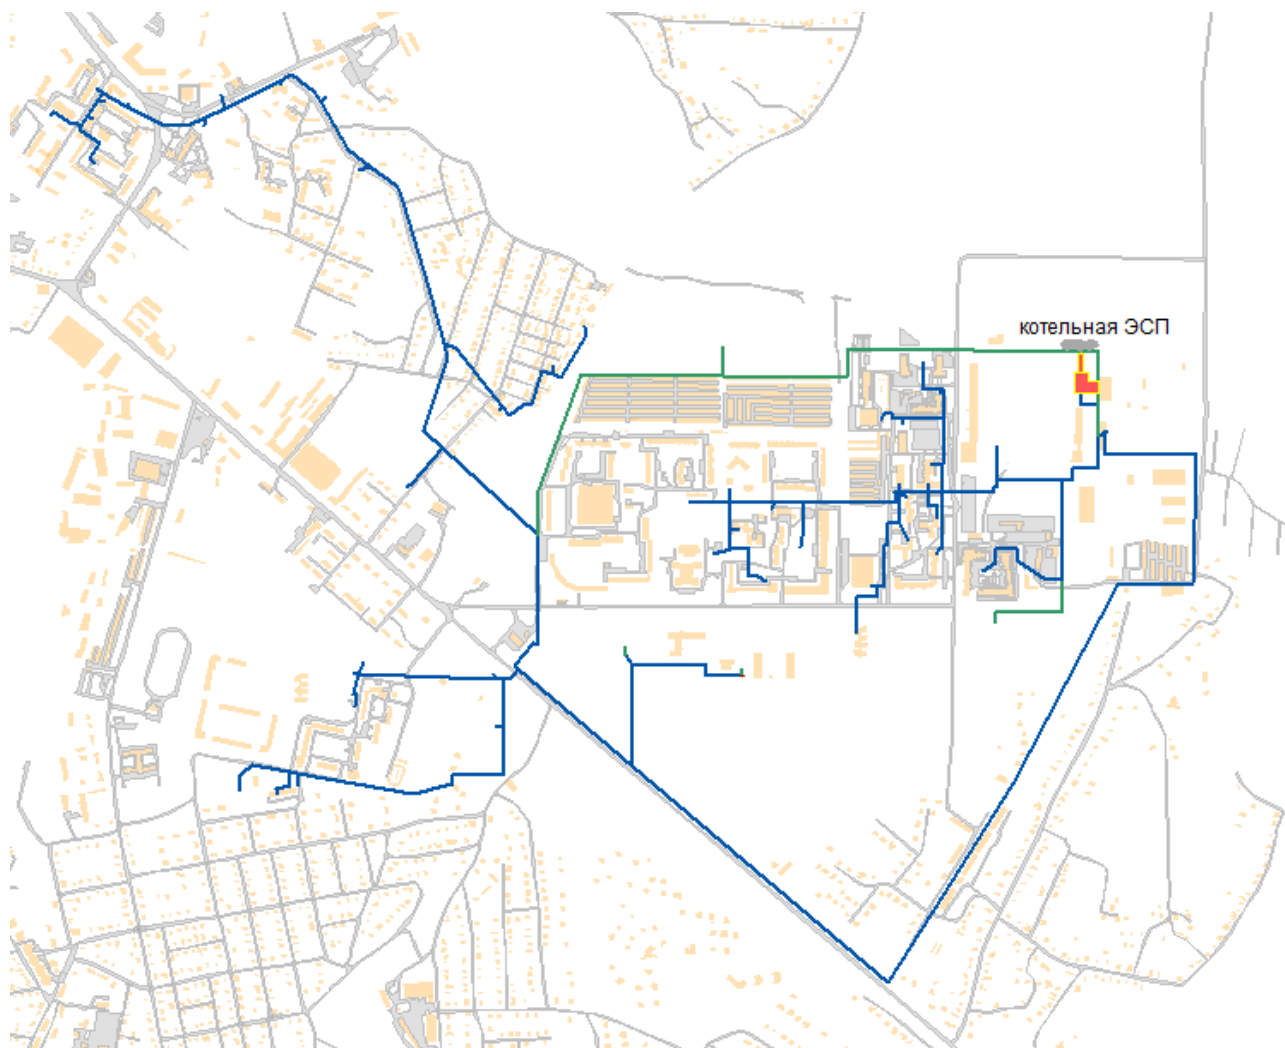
Схема теплоснабжения от котельной ОАО «ЭСР» с учётом строительства нового трубопровода
